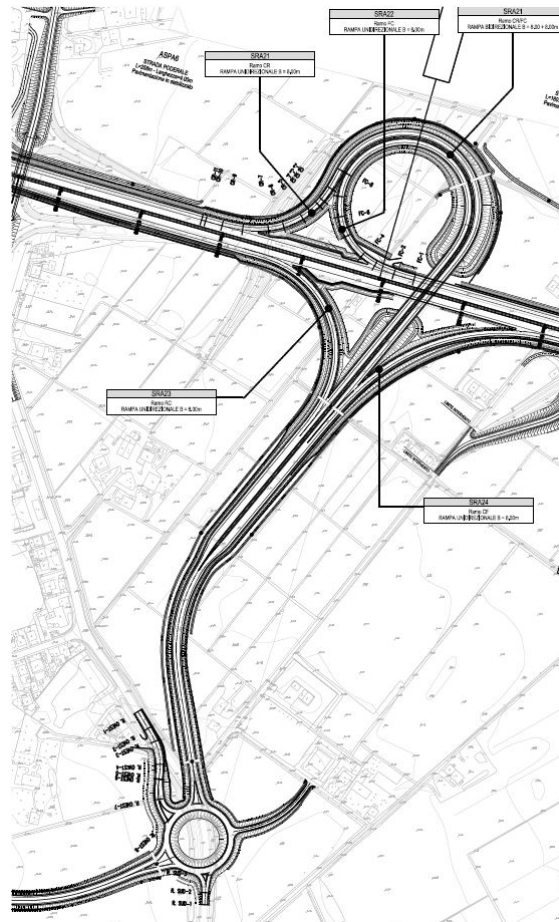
SCHEMA PLANIMETRICO SVINCOLO FERRARA SUD
